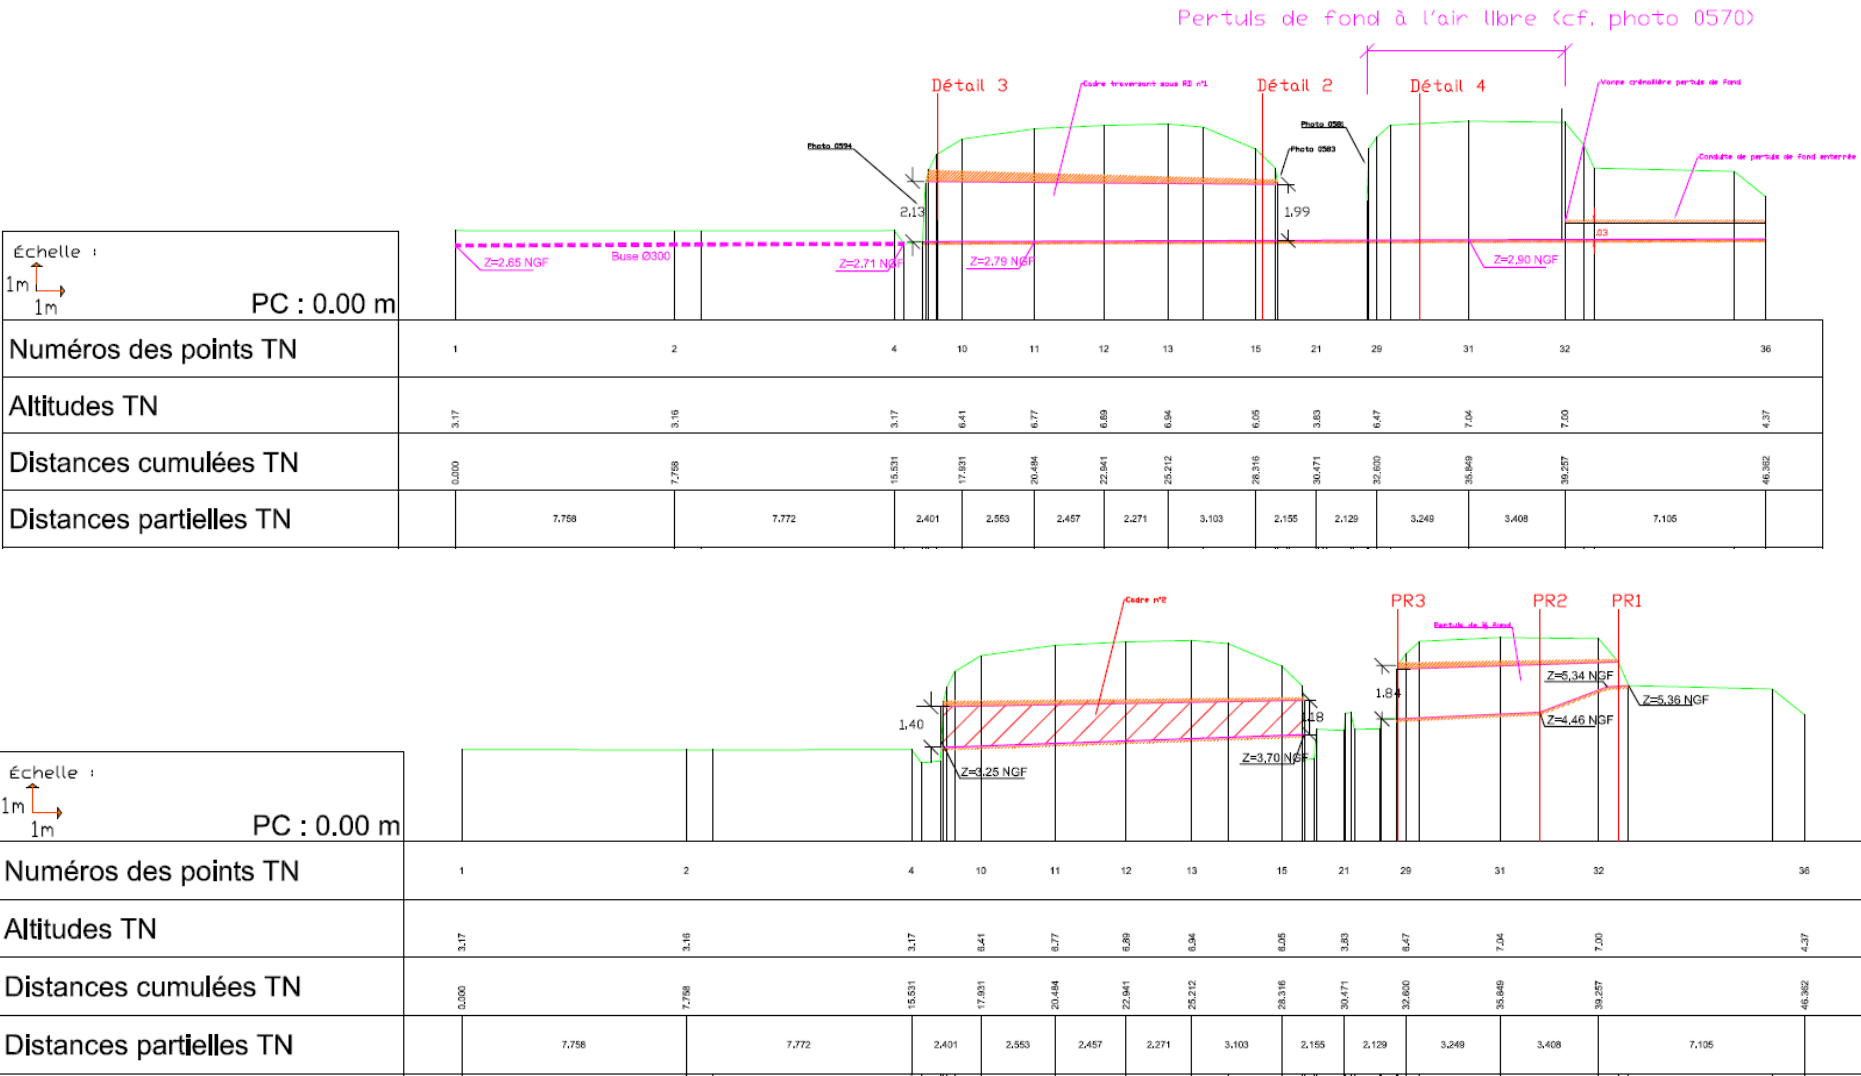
Profils en long : ouvrages traversant, puits de fond et demi-fond (BRL, 4)
